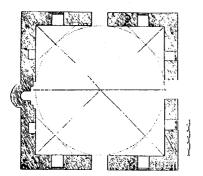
مسقط أفقى لجامع خسرو باشا ضمن مجمعة بحلب . (عن : Goodwin) .
